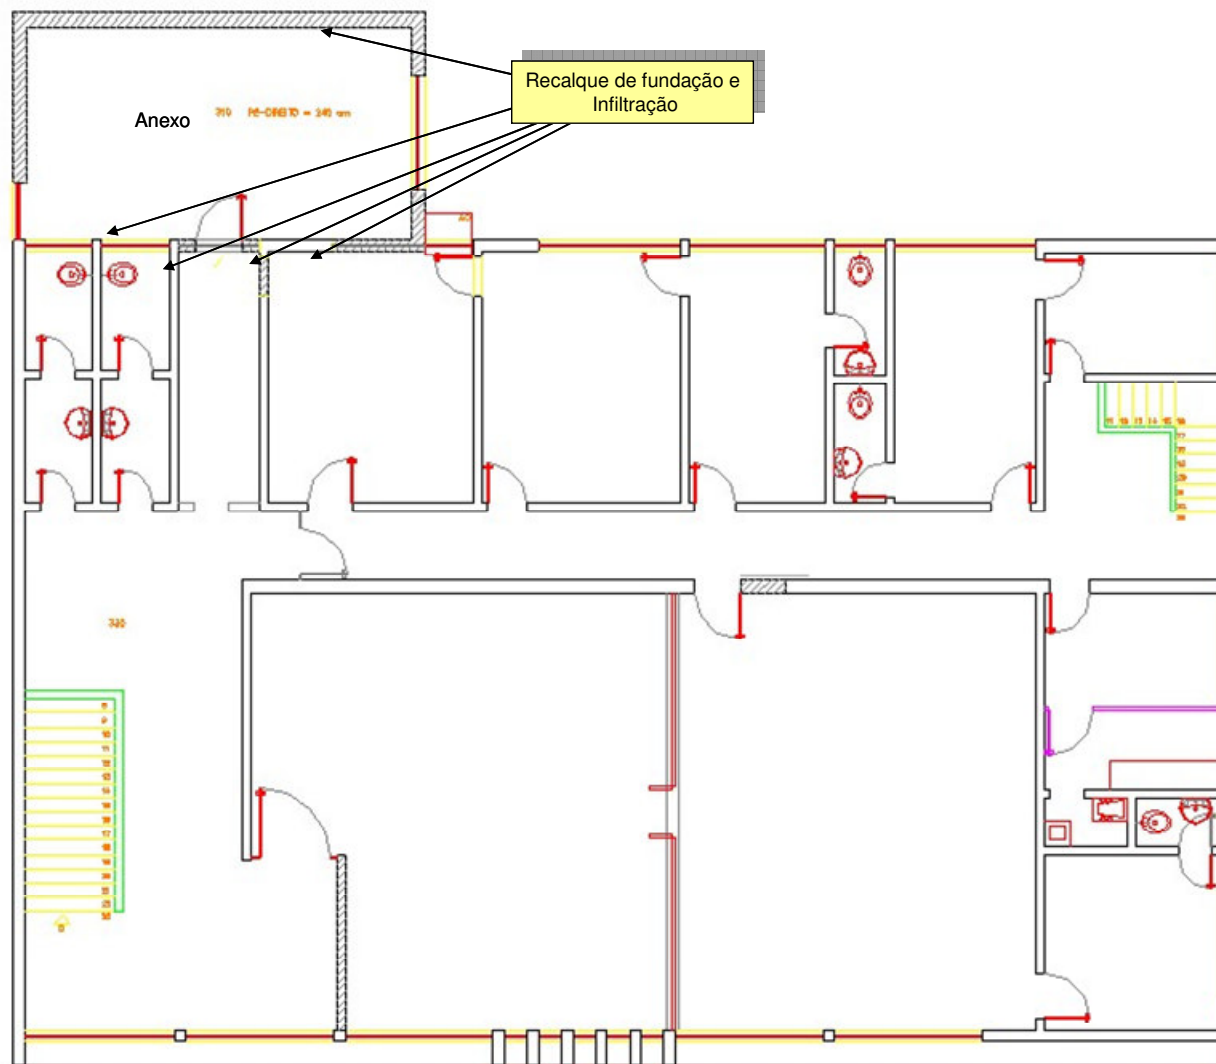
Planta do 2º pavimento e suas patologias.
